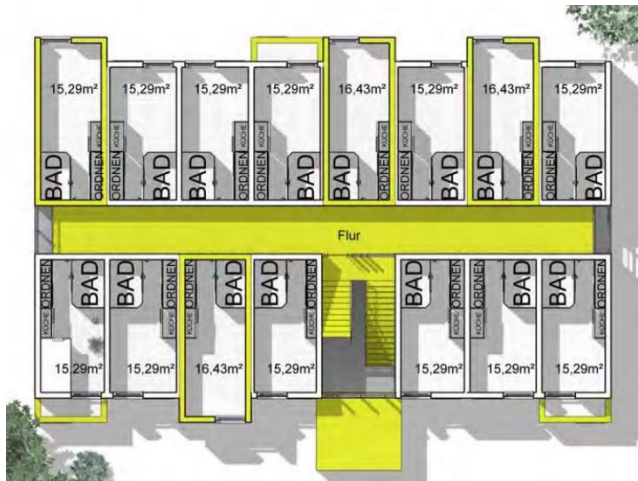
Grundriss Studentenwohnheim „STUDIKISTE“ [1]
